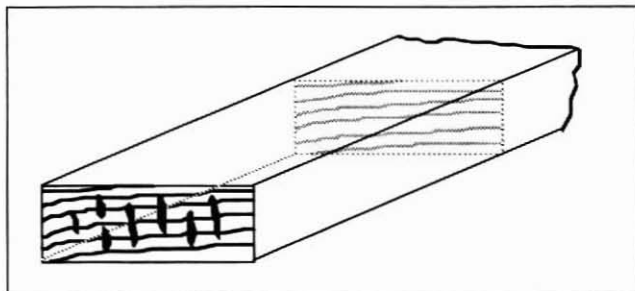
GRIETAS Y RAJADURAS EN LOS EXTREMOS
